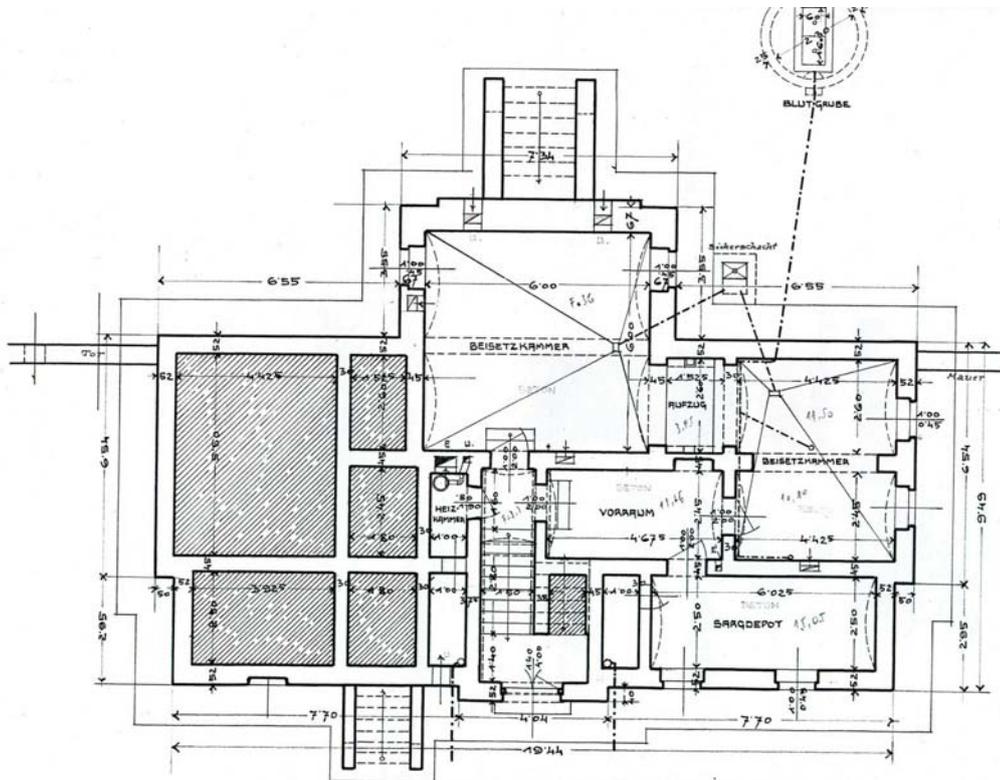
KELLERGRUNDRISS AUFBAHRUNGSKAPELLE
